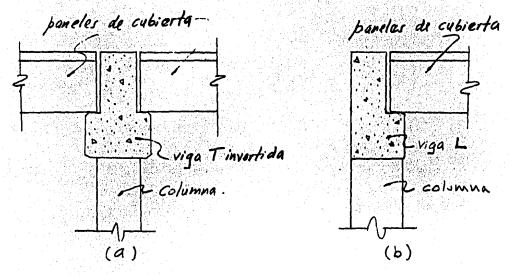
Secciones de vigas (a) T invertida y (b) sección L.
